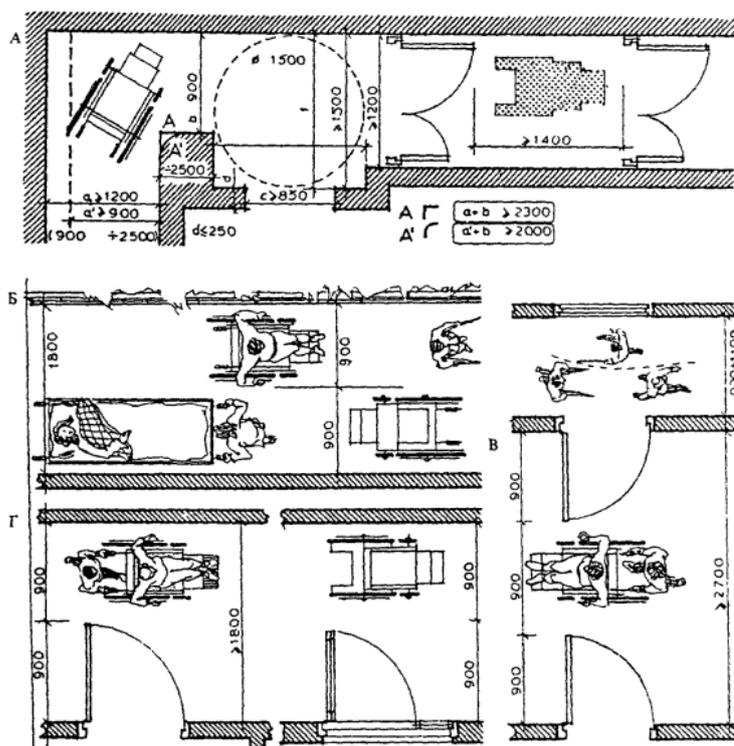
Общие габариты движения по коридору, людей с опорными приспособлениями
